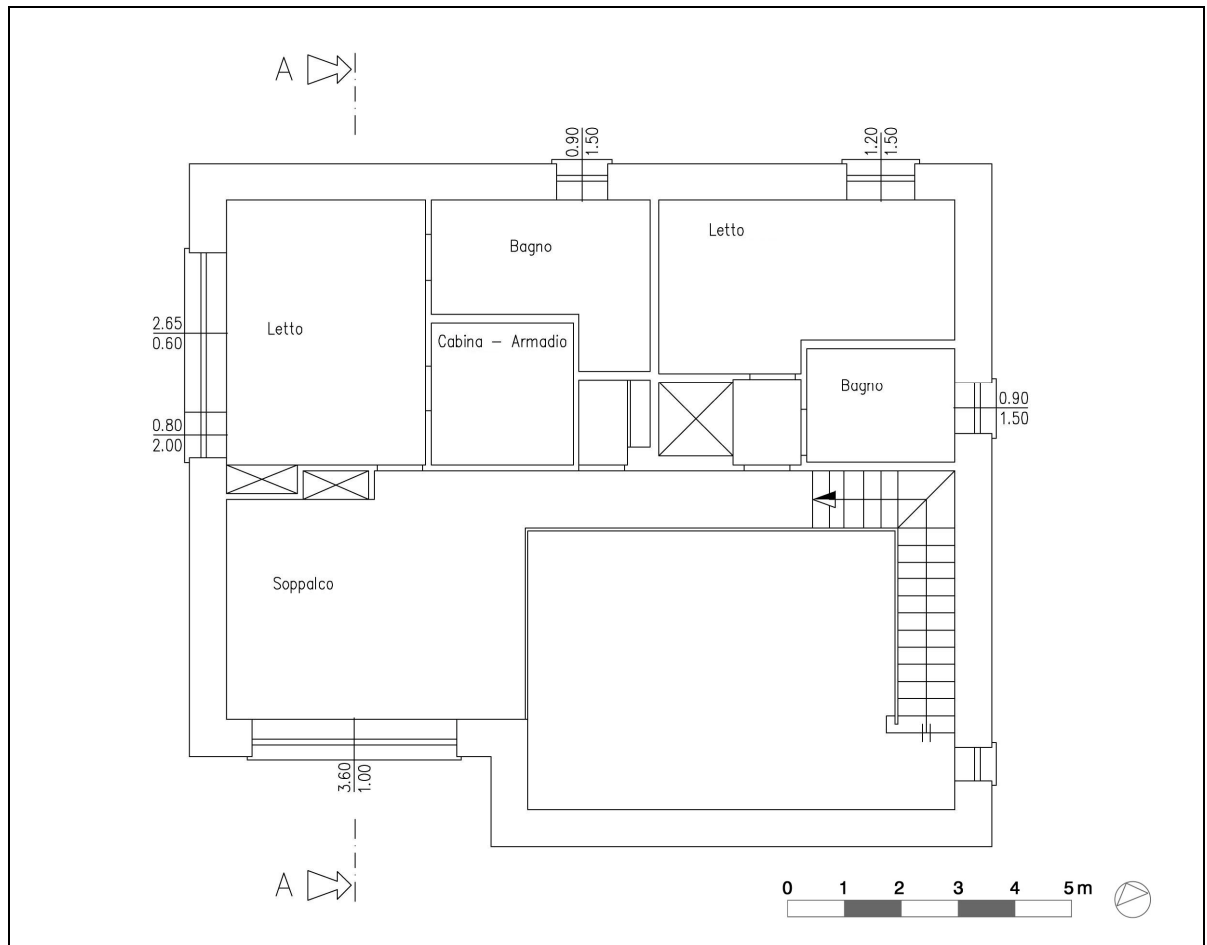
Pianta del primo piano della casa passiva di Carpi.
